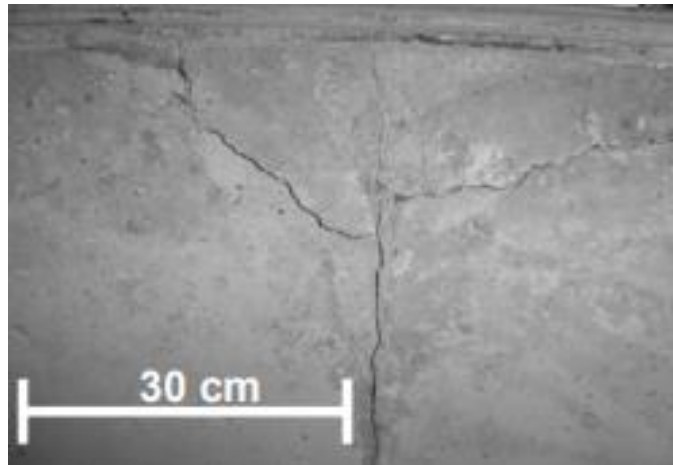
Exemplo de trinca em concreto refratário. Fonte: (MIYAJI, 2007).
